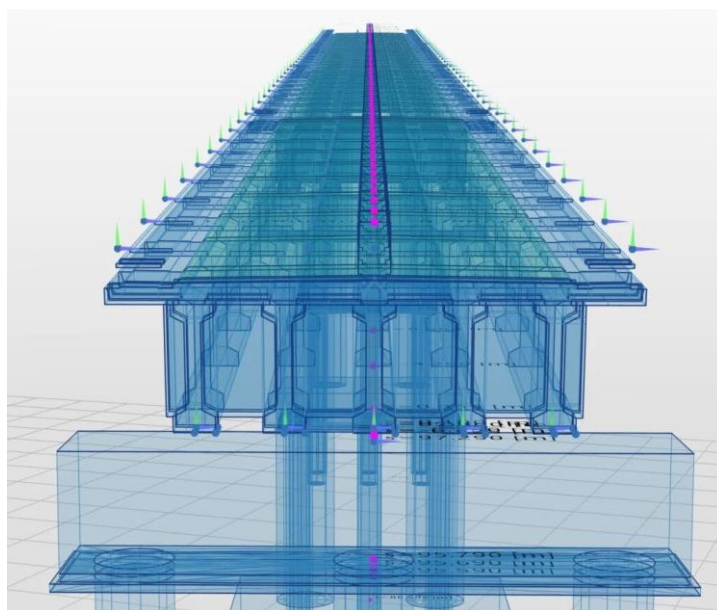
Exemplo da modelação de uma ponte no Allplan Bridge (Allplan, 2023)
